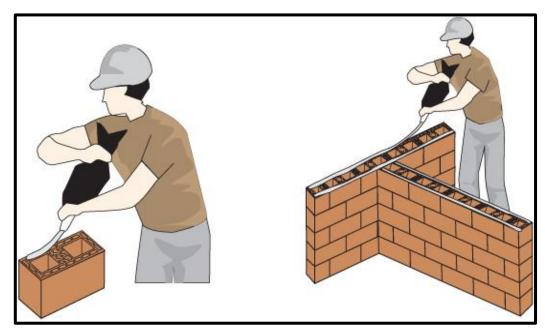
Aplicação de argamassa de assentamento em alvenaria estrutural (Fonte: www.selectablocos.com.br)
